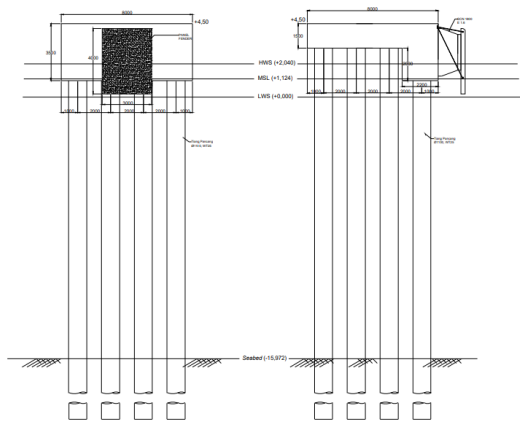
Detail Potongan Tampak Samping Pelat *Loading Platform
